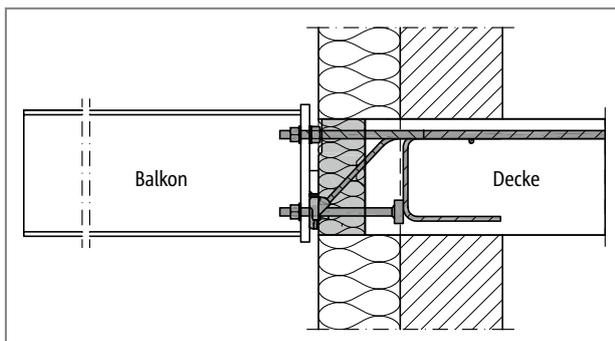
Schöck Isokorb® T Typ SK: Dämmkörper schließt mit Hilfe des Deckenvorsprungs außen bündig mit der Dämmung der Wand ab, dabei sind die seitlichen Randabstände zu beachten
